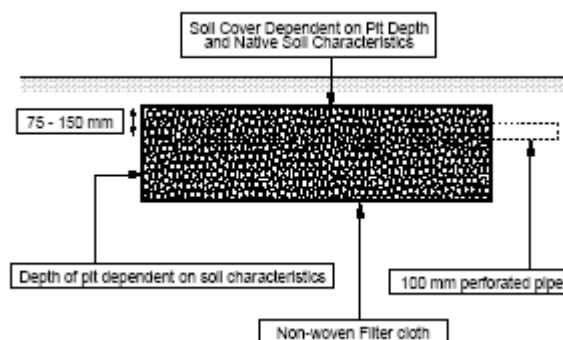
Esquema da caixa de pedras para armazenamento e infiltração da águas pluviais no solo.
